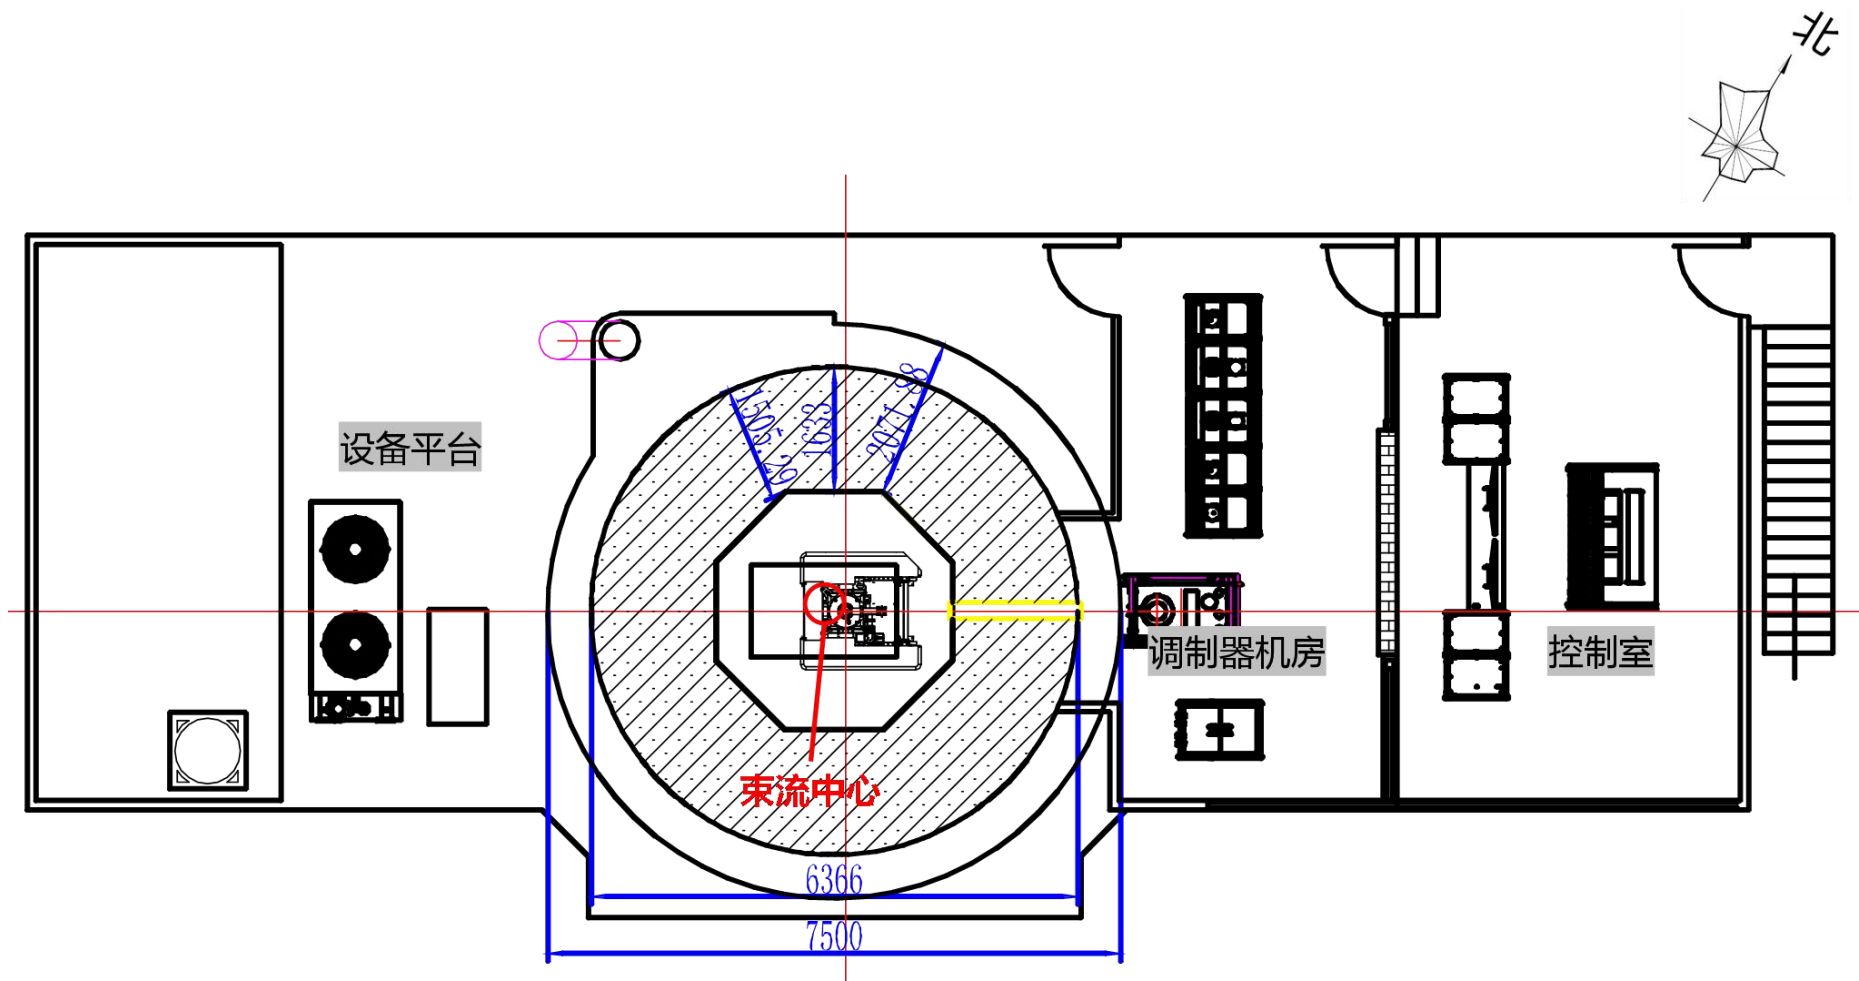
地上二层主机室屏蔽参数及尺寸图（平面图，单位 mm）
